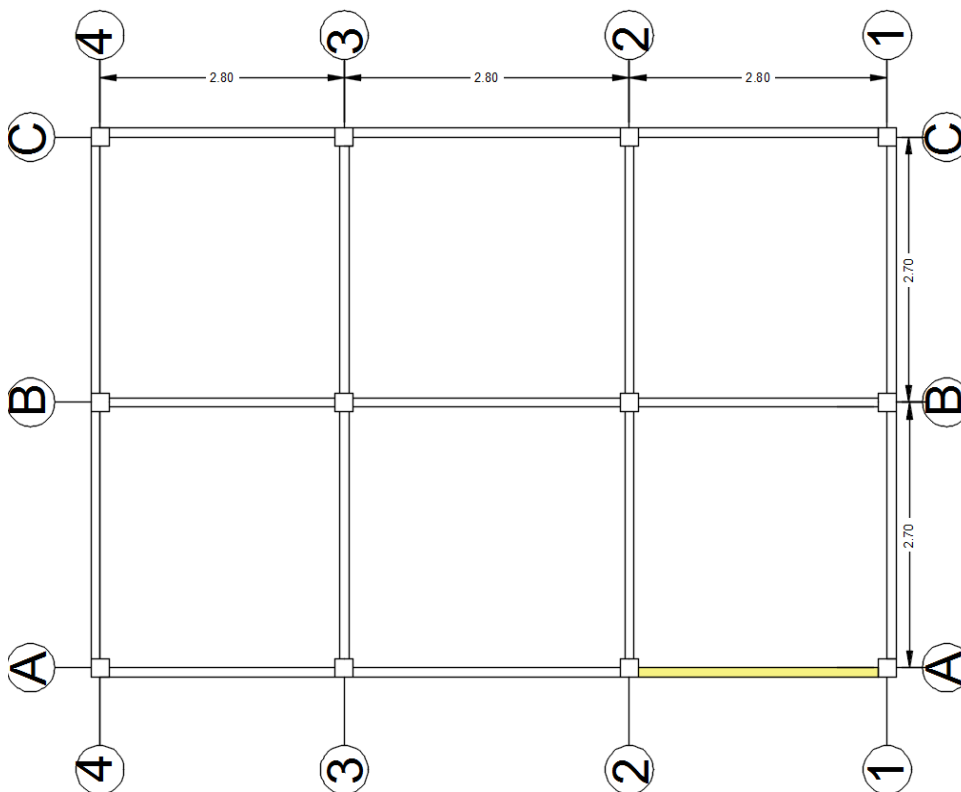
vista en planta segundo piso de la viga analizada eje A entre 1-2
